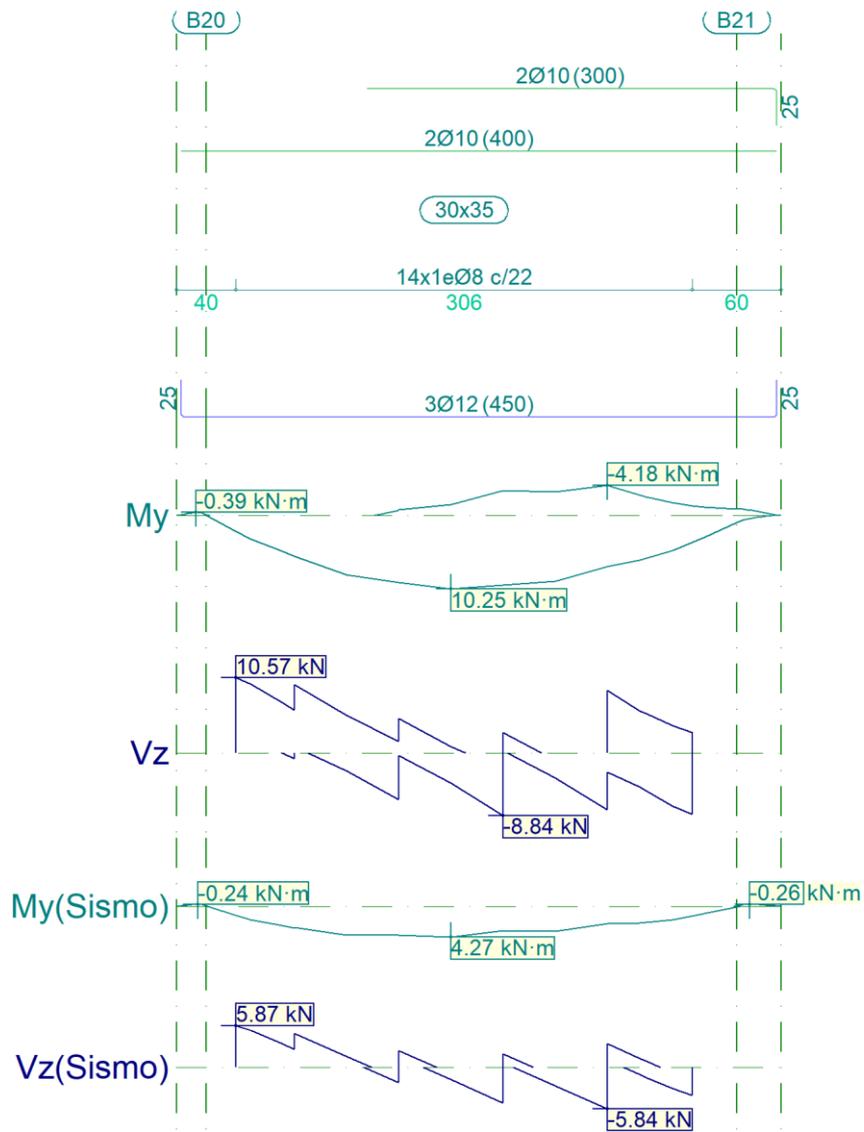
ESFUERZOS VIGA P13-P14.
